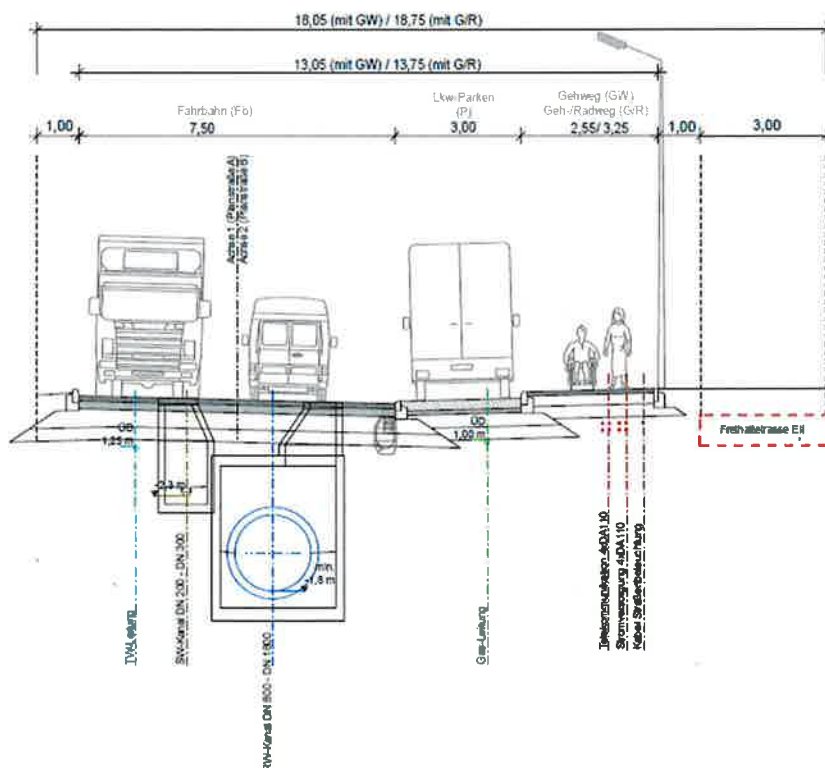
Geplanter Regelquerschnitt Planstraßen A und B<sup>27</sup>
